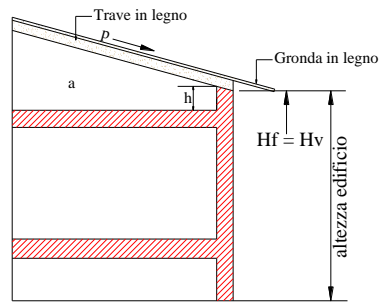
Edificio con tetto ventilato e gronda inclinata
